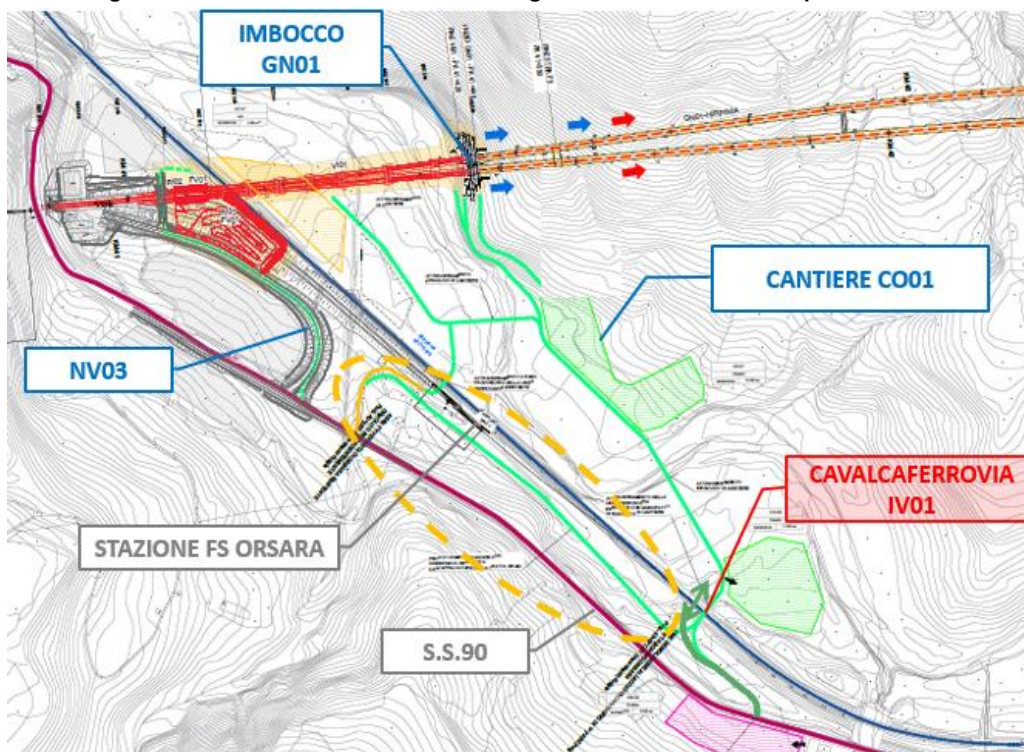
Proposta viabilità di accesso ai cantieri – Progetto Esecutivo
